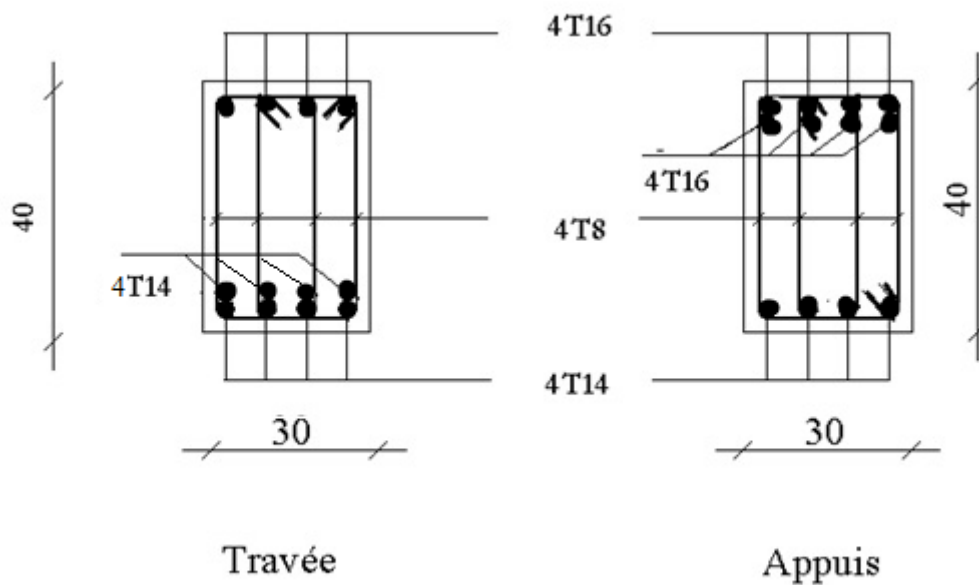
ferrailage des poutres non porteuses (30x40).
